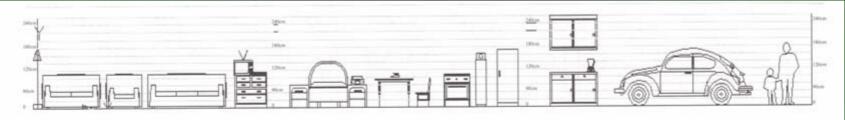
Menaje para la vivienda tipo II (una sola planta)
